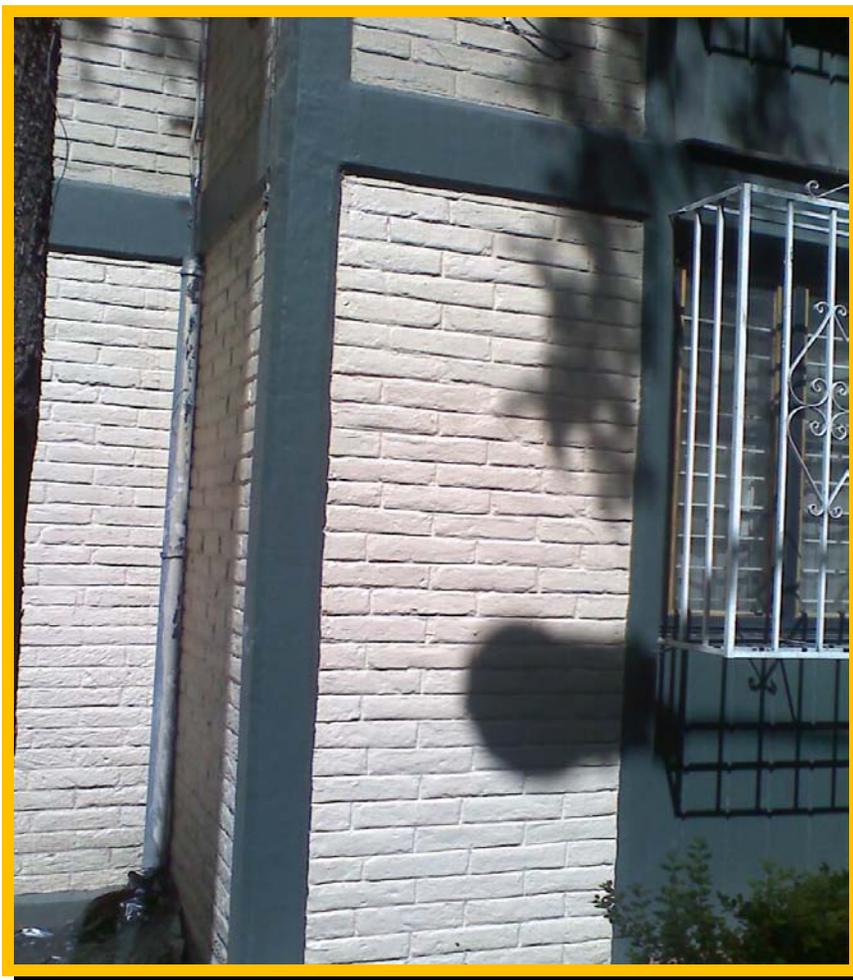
Elaboración de banquetillas y sellado de poliuretano y bajadas pluviales.
